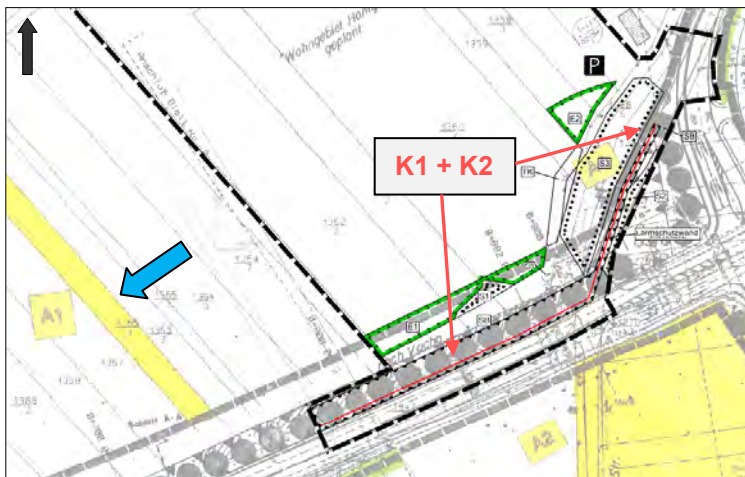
Aktueller Änderungsplan mit Lage der Lärmschutzwand (blauer Pfeil)
